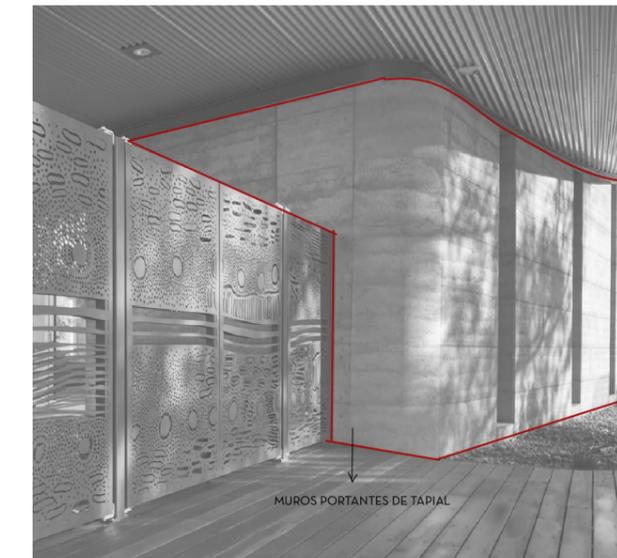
Esquema análisis constructivo/estructural PAMS. Fuente: Elaboración Propia
